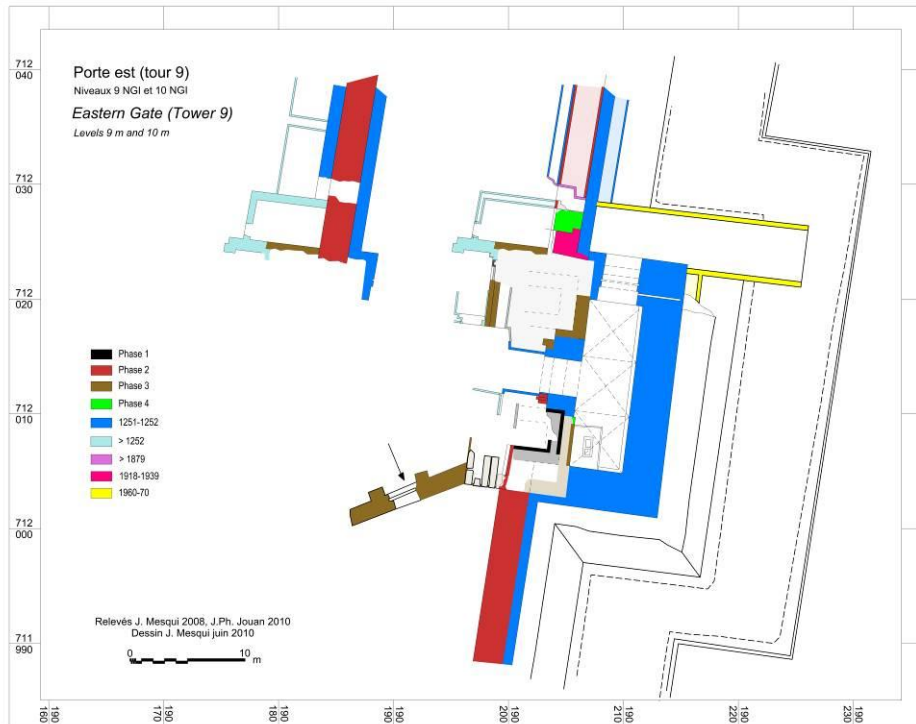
Plans de la tour aux niveaux 9 et 10 ASL
